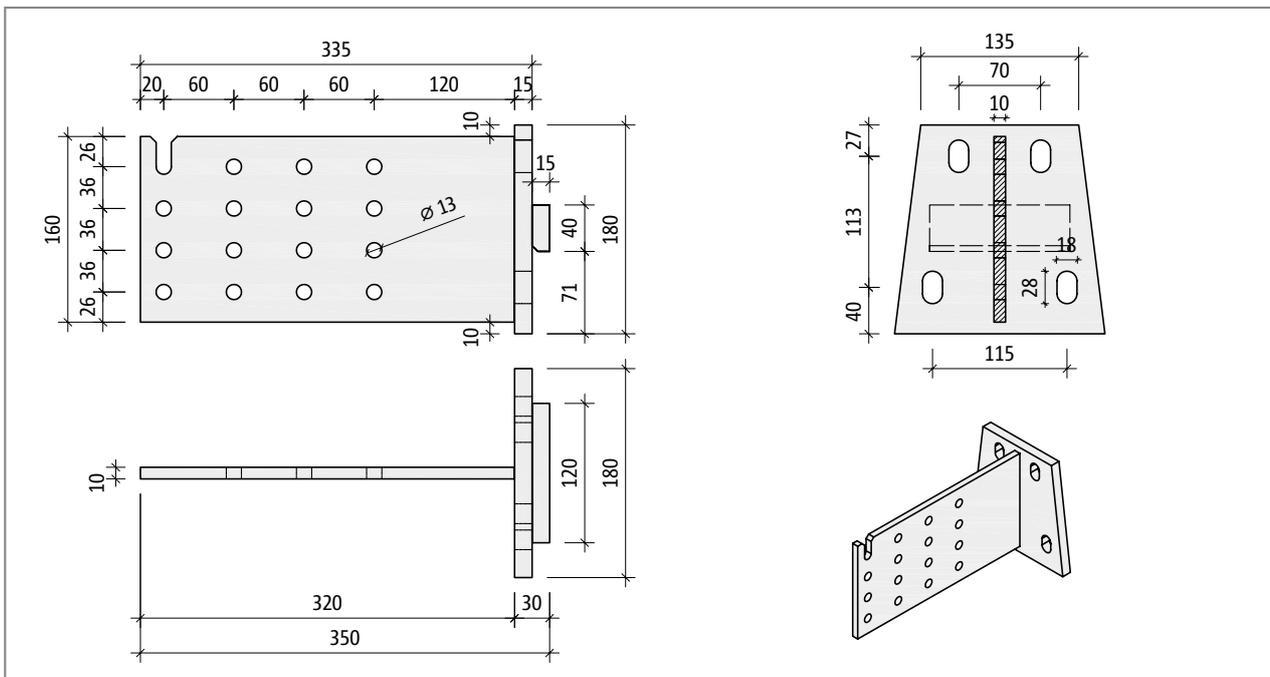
Schöck Isokorb® T Typ SQ mit Stahlschwert: Stahlschwert mit Stirnplatte und Knagge
